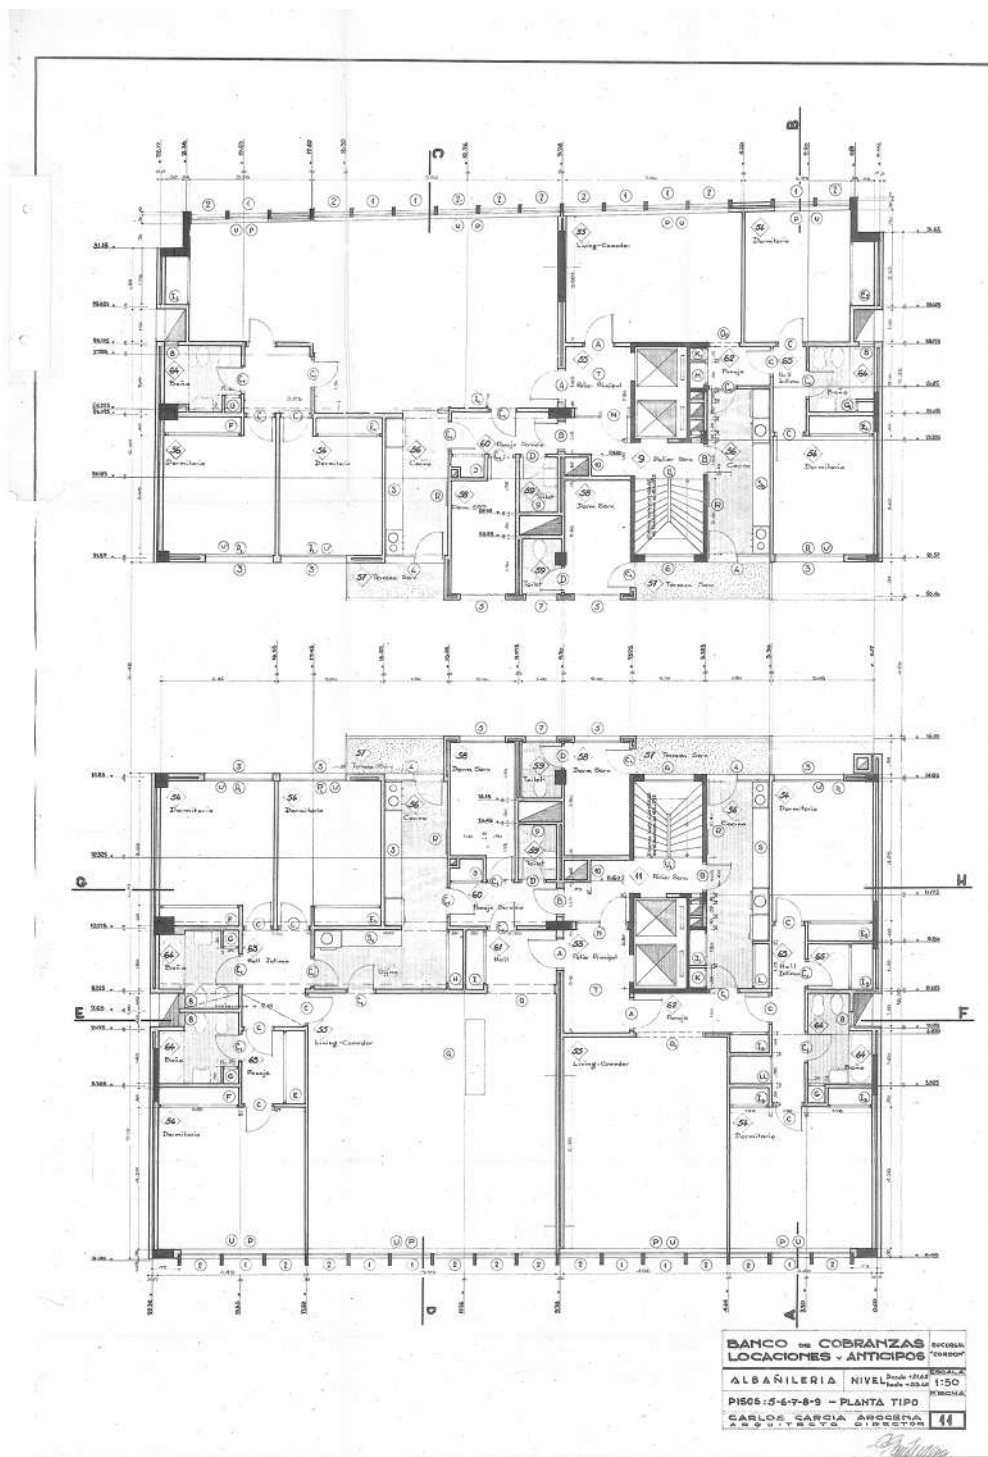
Planta tipo del sector de viviendas del proyecto del BCLA presentado a la IMM en 1959.
